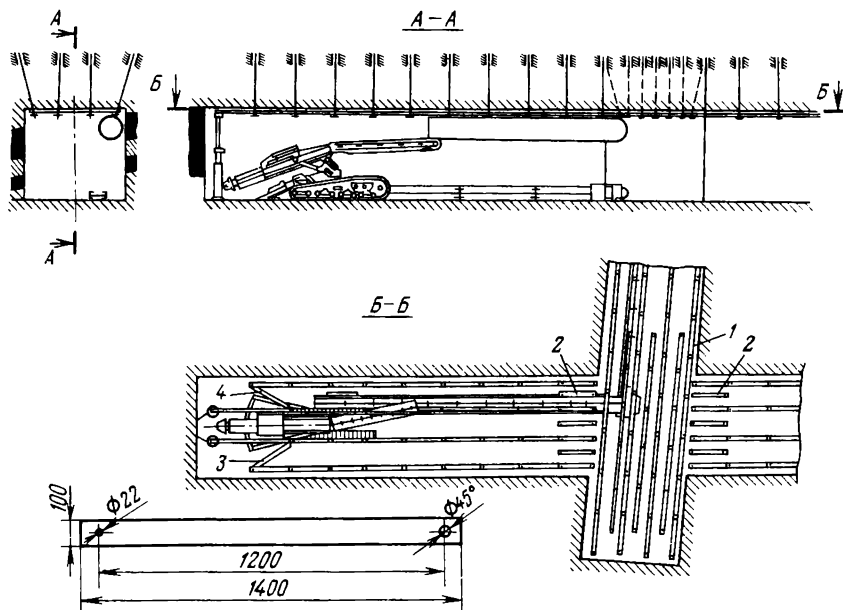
Схема крепления пород кровли пласта на пересечении горизонтальной выработки с наклонной
